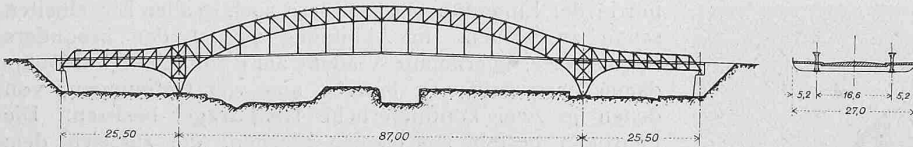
Bornholmerstrassen-Brücke in Berlin. — Systemplan 1:1500.
